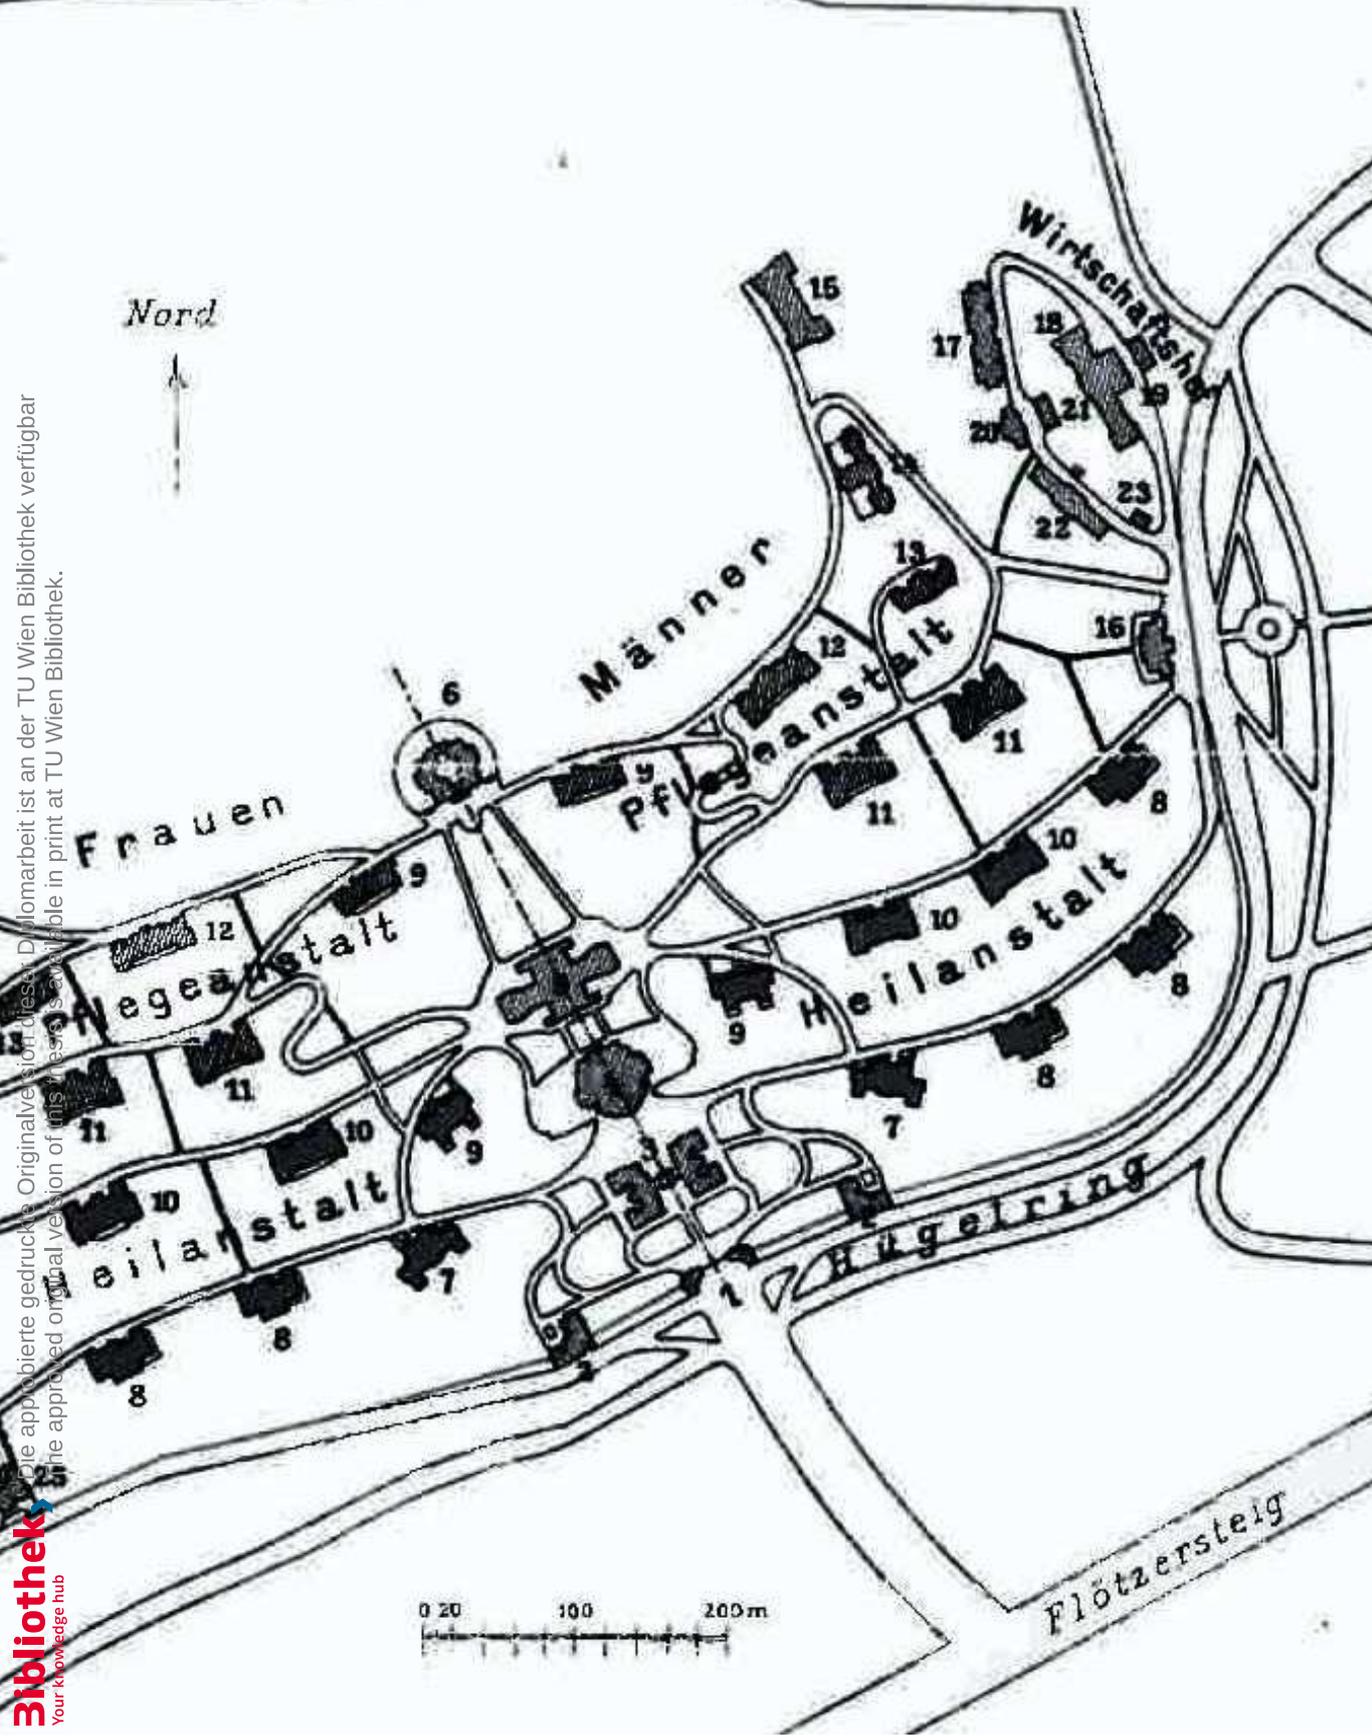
Lageplan des Baues der neuen N.Ö. Landes-Irrenanstalt in Wien (M: 1:5000)
